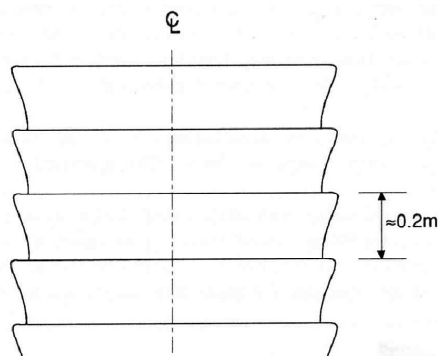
Seção transversal da cortina interior de betão betuminoso após compactação (Höeg, 1993).
